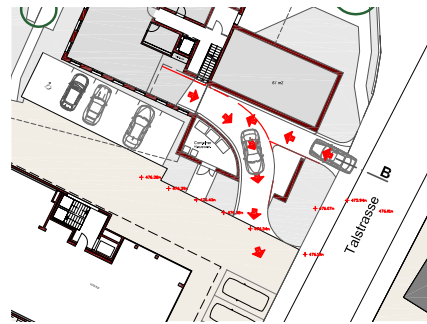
Einstellhalleneinfahrt Variante B, Ducksch Anliker Architekten, März 2017
